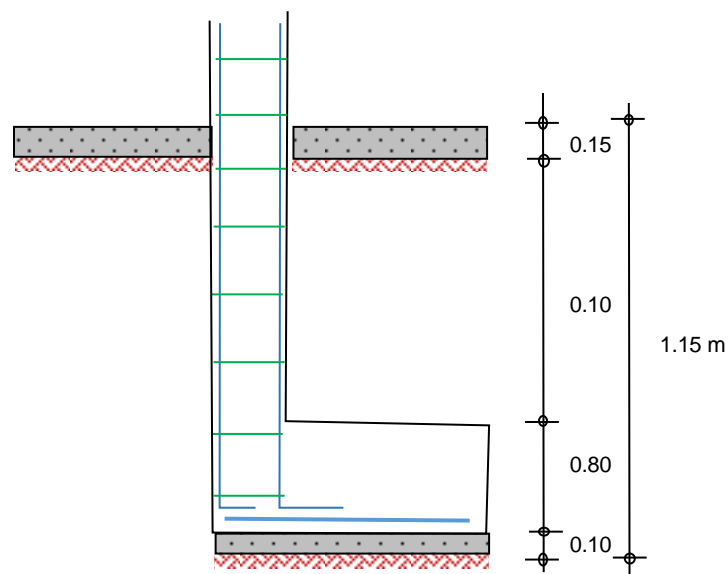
Detalle de sección de zapata esquinada (Estructura 1).
